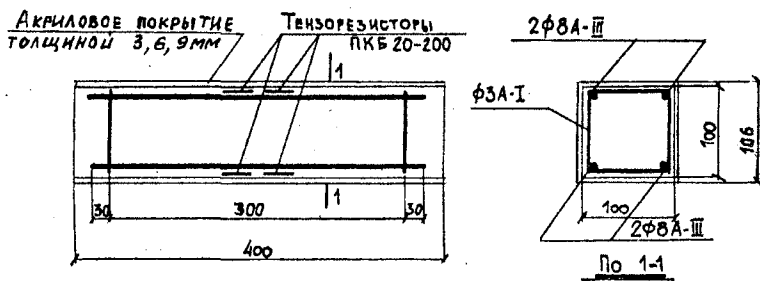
Размеры и схема армирования покрытий акриловым полимерраствором железобетонных призм
